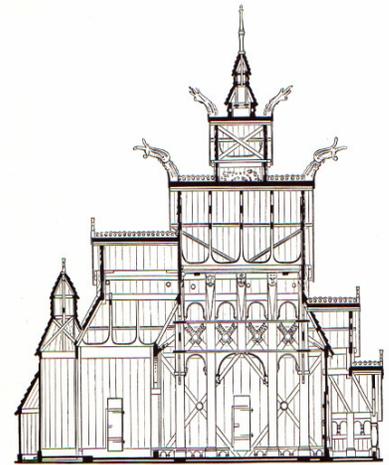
Estructura de madera del año 1250 en Hallingdal, Noruega. Hecha con columnas y armaduras de madera.
